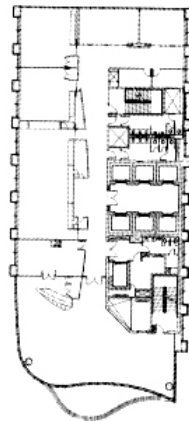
Planta do pavimento tipo –25º (Fonte: Revista Projeto 269, 2002)
